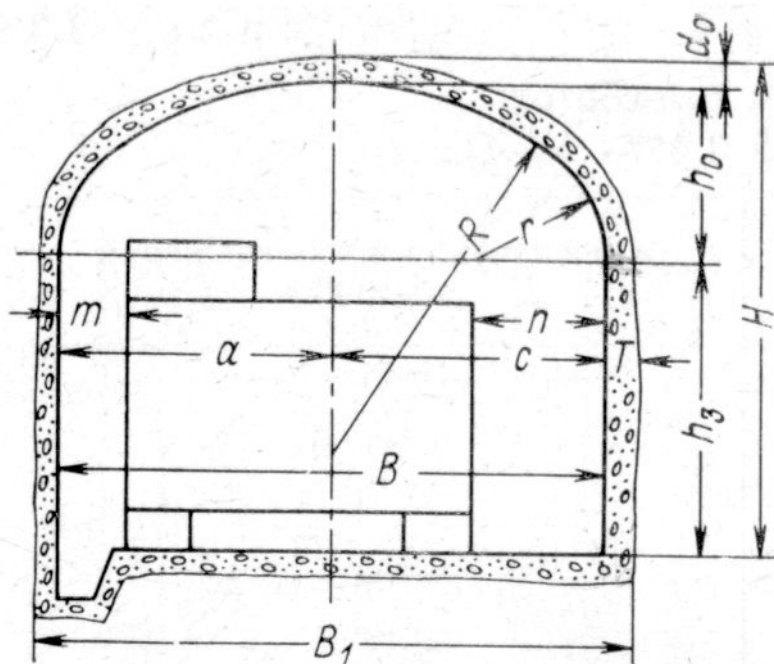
Конструктивные размеры поперечного сечения выработки, закрепленной бетонной крепью при применении самоходной техники
